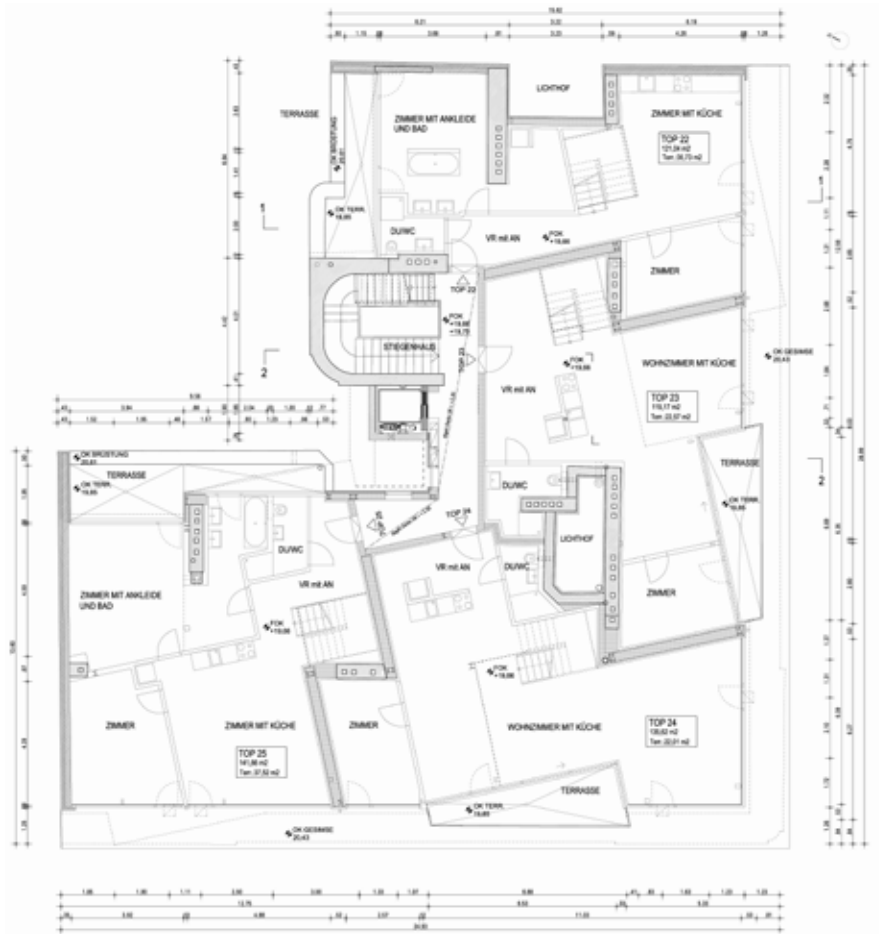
\_ Grundriss D1 © Holodeck Architects
